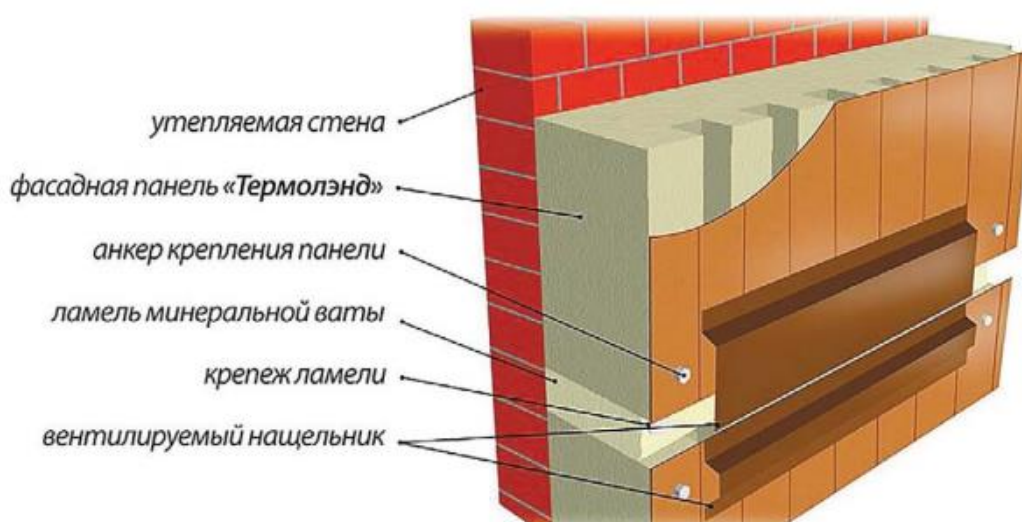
Фасадная система утепления зданий на основе панелей с вентилируемыми каналами
